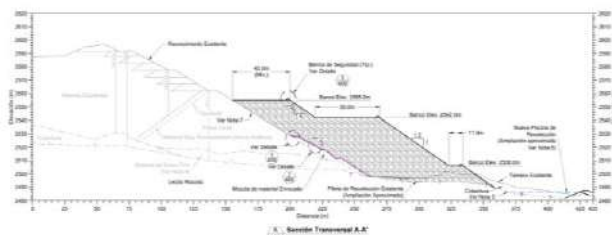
Perfil tipo del refuerzo, primera fase de construcción.
